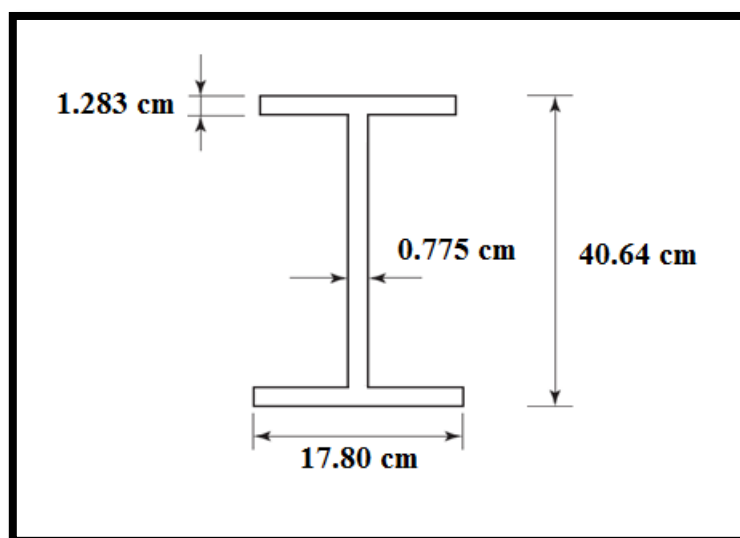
Disposición final del perfil de la viga W16 x 40.
